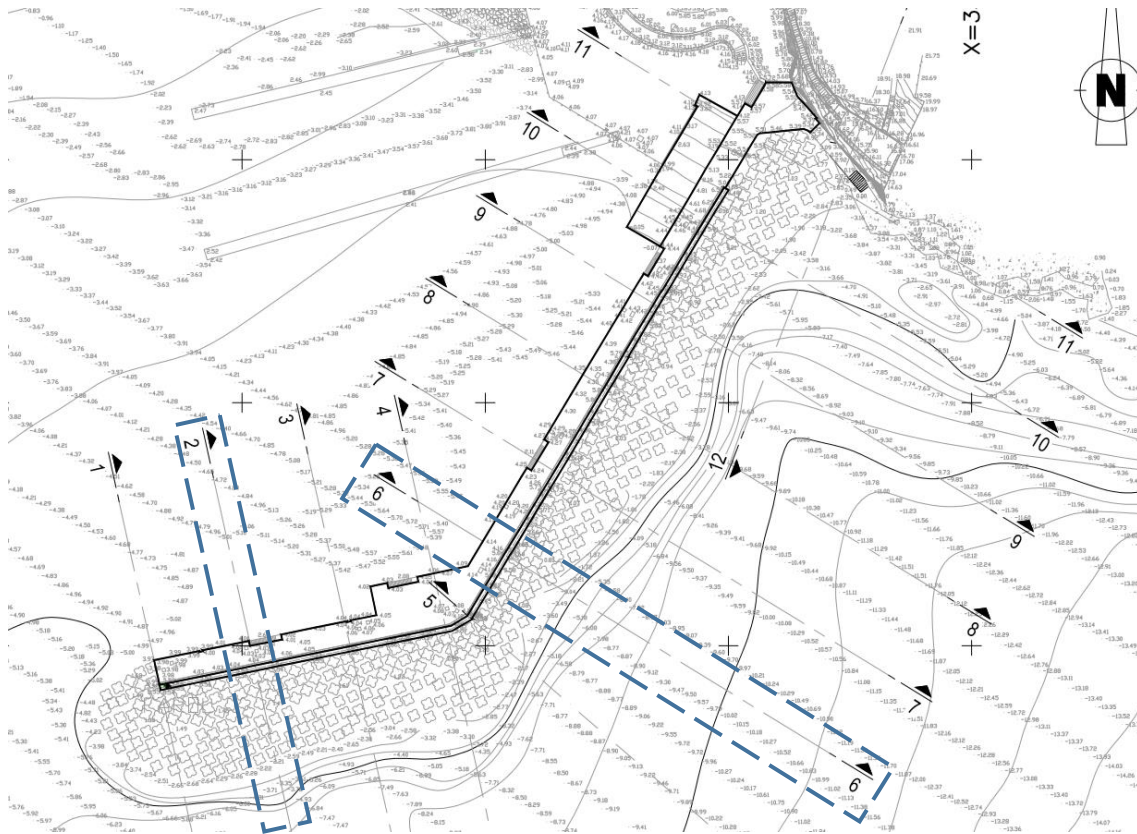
Enquadramento em planta dos cortes 2-2 e 6-6
